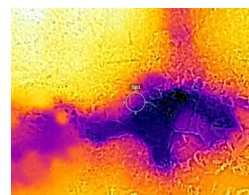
写真-8 下方仮排水路の流水(赤外線画像)
